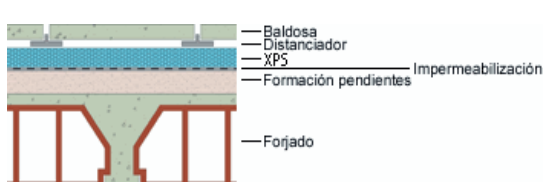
Detalles constructivos para azoteas invertidas no transitables y transitables.
